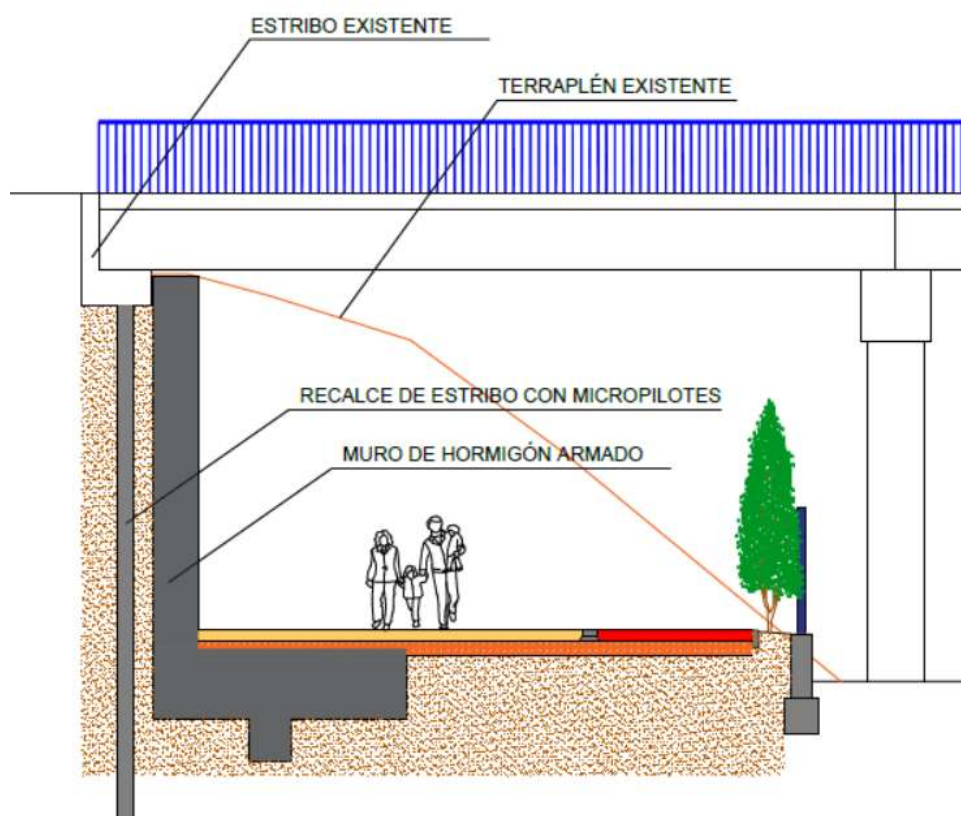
Croquis las estructuras proyectadas. Fuente: propia
